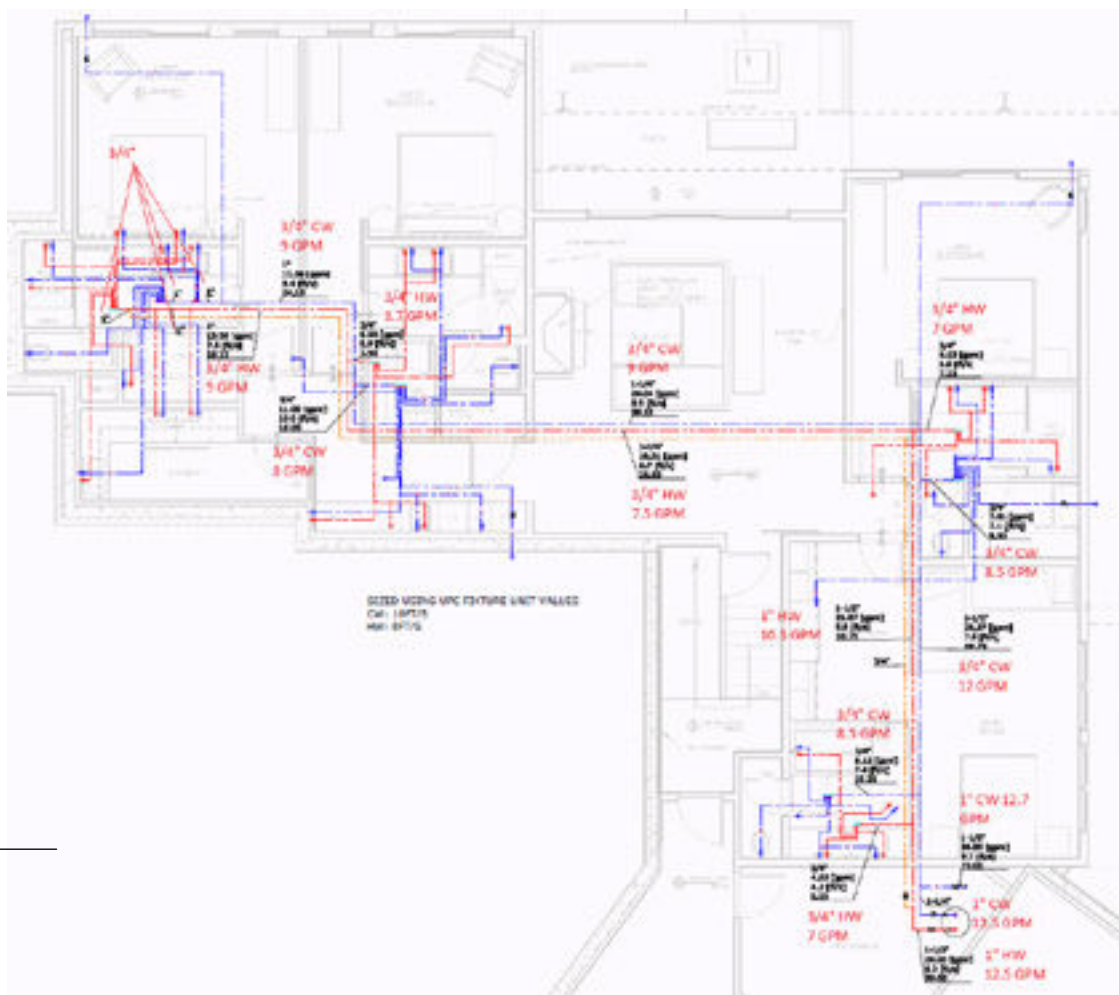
toont een plattegrond van de kelder van een woonhuis met drie badkamers. Het woonhuis bestaat uit twee bouwlagen: kelder en begane grond. De leidingwaterinstallatie voedt 13 waterbesparende kranen verdeeld over drie toiletten, drie douches, vier wastafels, een keukenaanrecht, een vaatwasser en een wasmachine. Vlotterkranen van closetreservoirs en kranen voor de vaatwasser en wasmachine zijn in principe geen waterbesparende kranen (deze kranen vullen de toestellen), tenzij deze worden 'gesmoord' met als gevolg langere vultijden. Op de plattegrond staan de verdeelleidingen in de kelder getekend die de bovengelige bouwlaag voedt.
